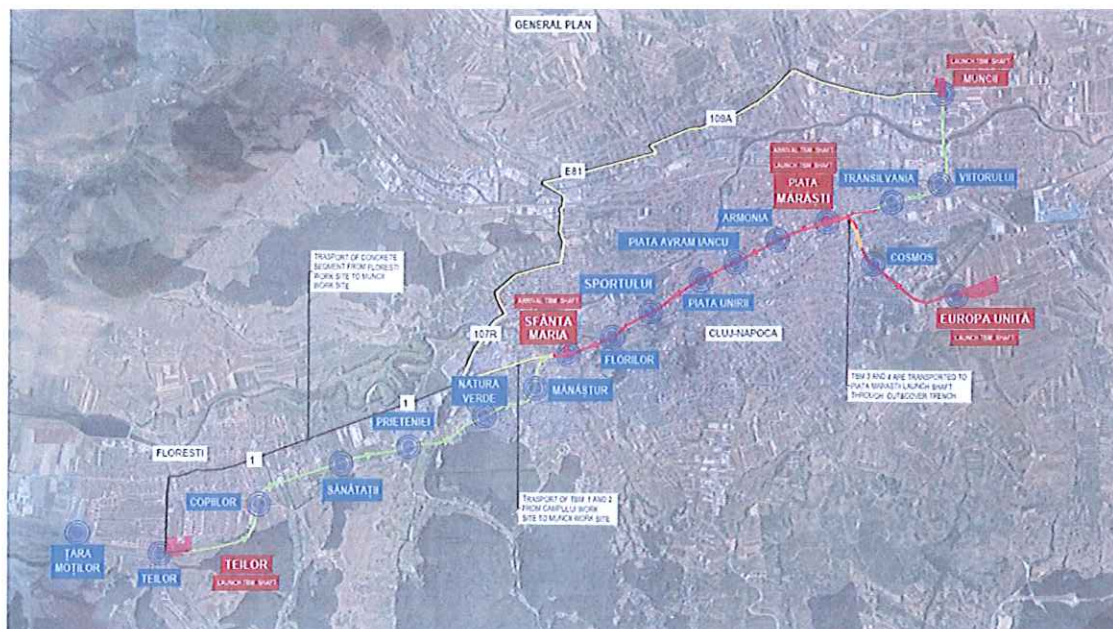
Plan general pentru amplasarea organizărilor de șantier
